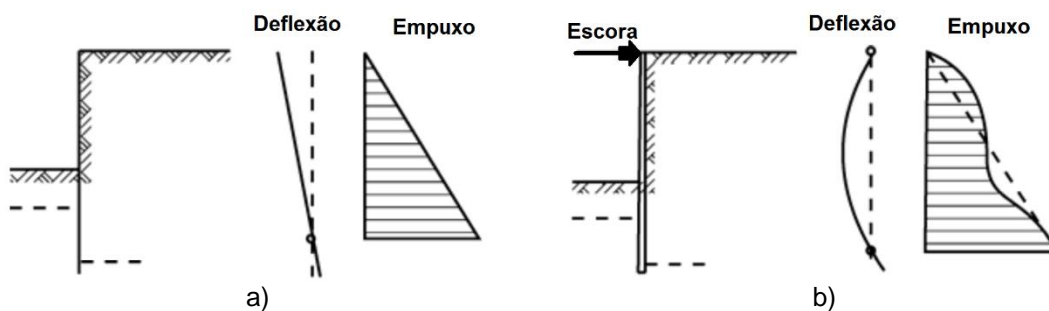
Distribuição das tensões laterais - a) Estrutura rígida em rotação – b) Estrutura Flexível.
